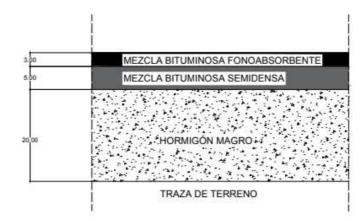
Sección transversal calzada. Fuente: Elaboración propia.
